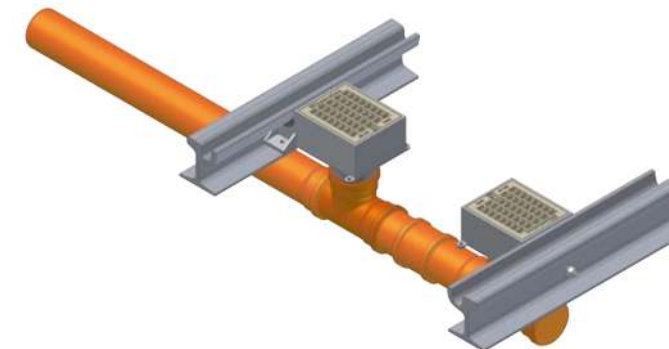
Detalle de los elementos que permiten desaguar los carriles en las secciones con terminación en césped.
